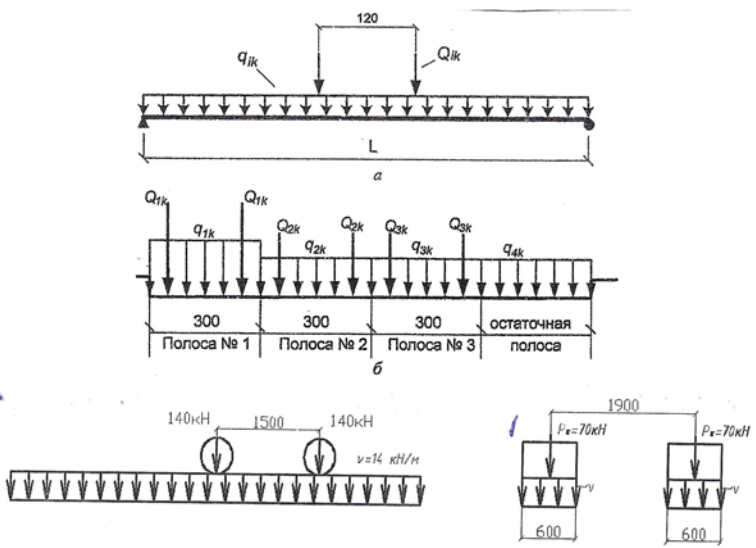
Схема загрузки LM1: *a* – продольная установка нагрузки на пролетном строении; *б* – поперечная установка нагрузки на пролетном строении; *в* – схема временной автомобильной нагрузки
